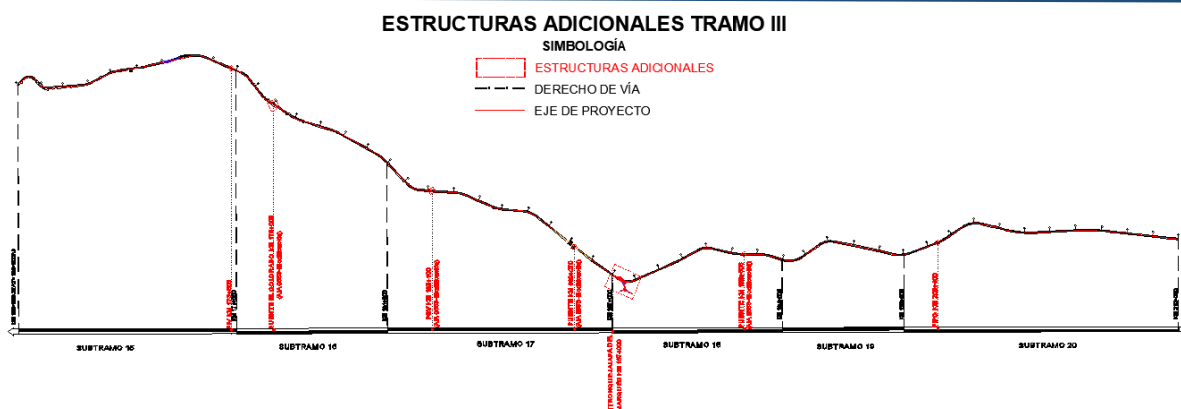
Ubicación de las estructuras adicionales a lo largo del eje del tramo III.
